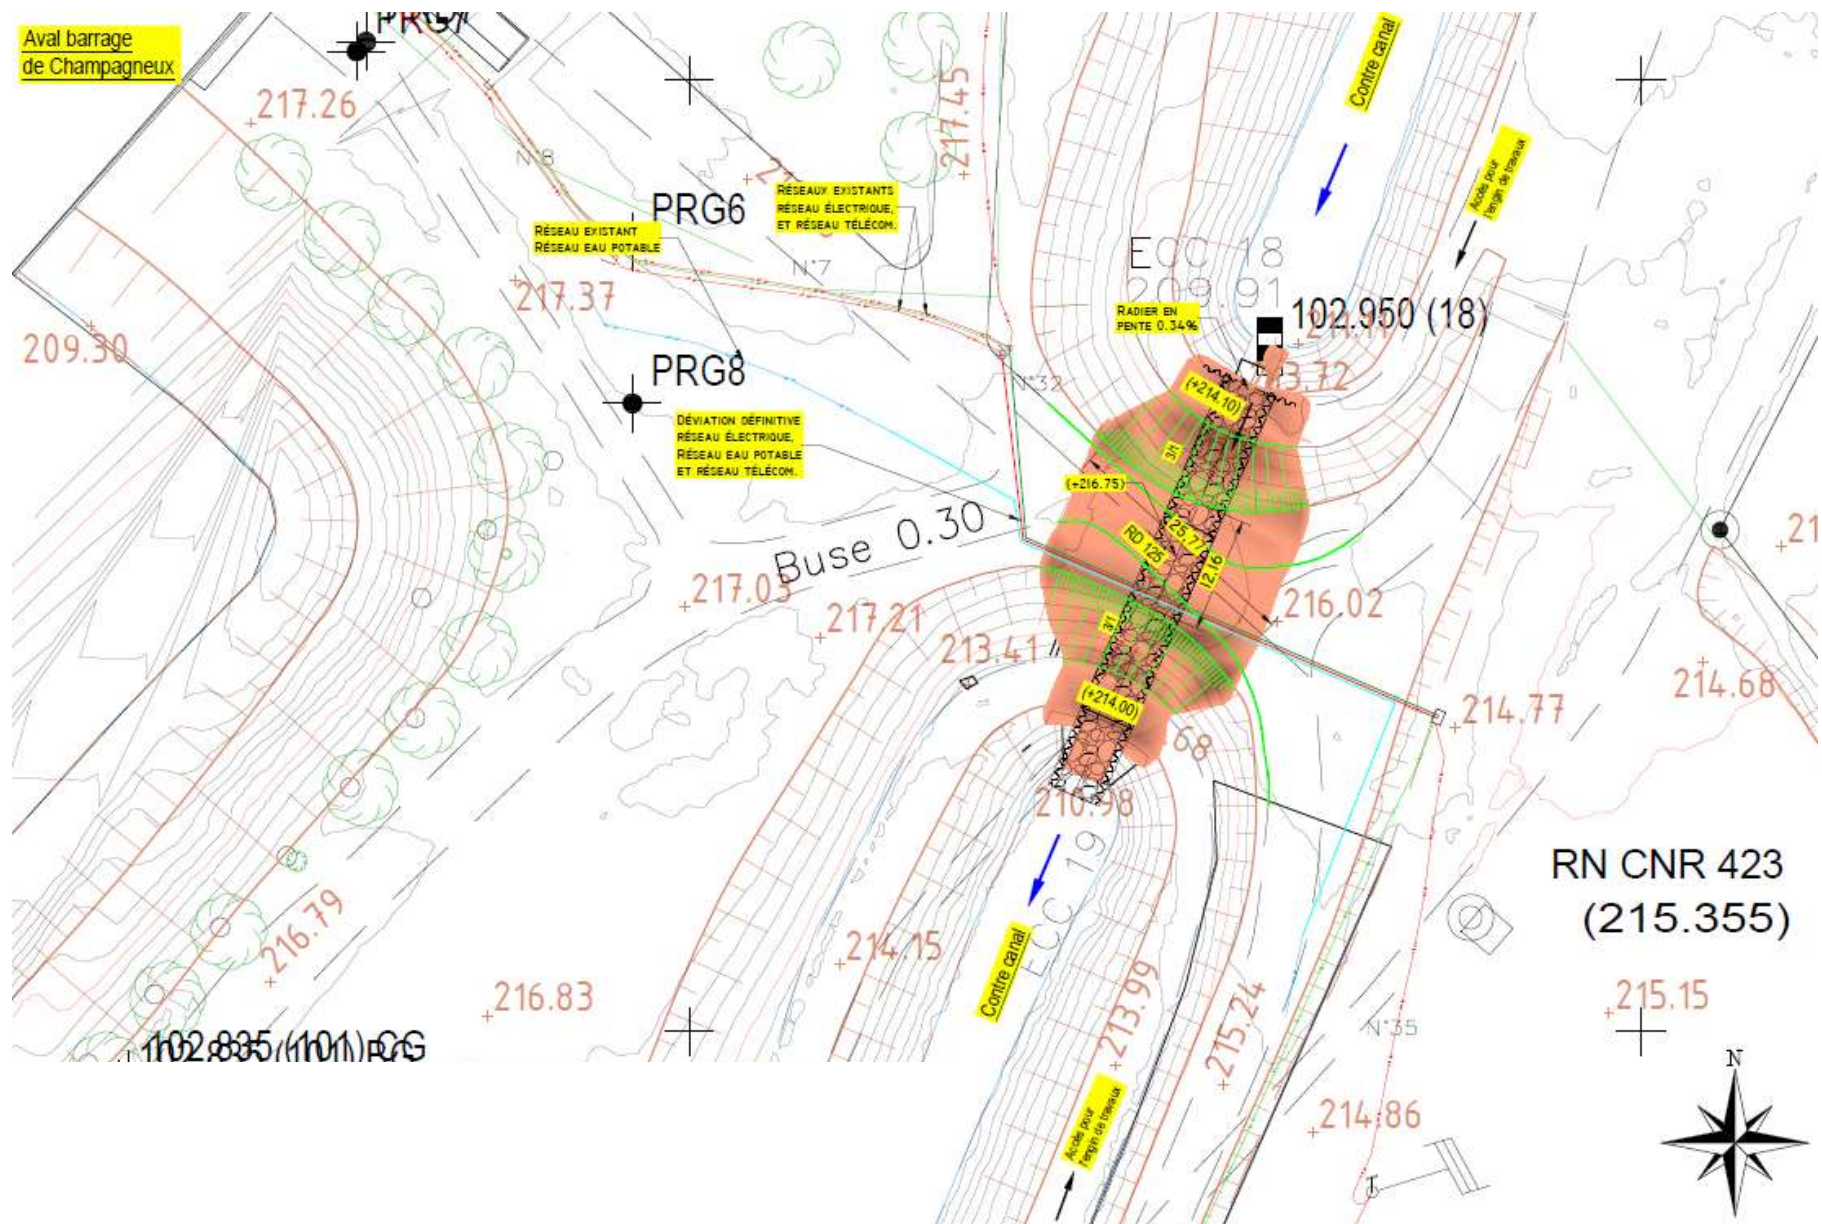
Plans décrivant les travaux – Etat final post travaux – Vue en plan.
